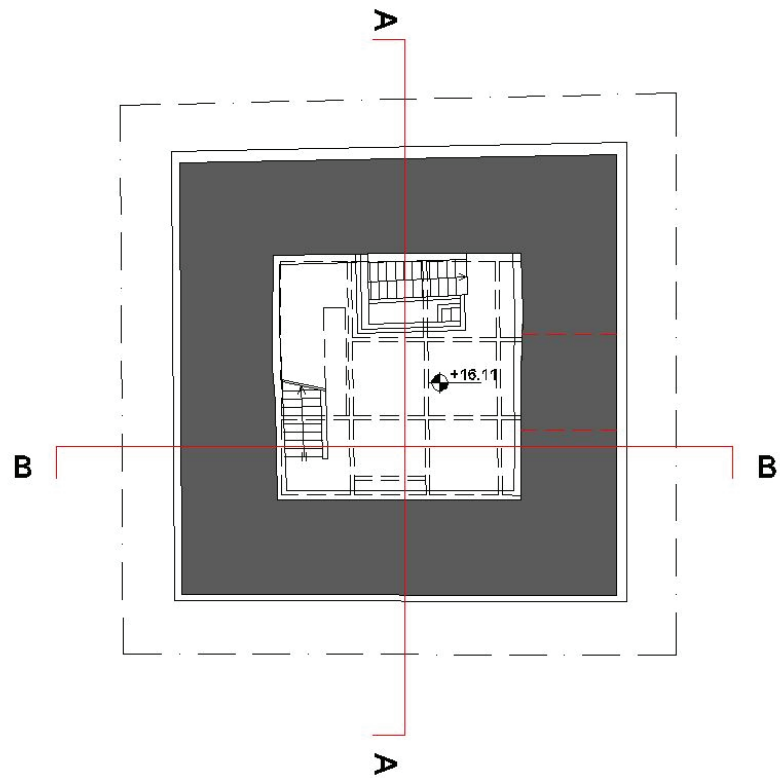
Pianta piano terzo della torre campanaria - Chiesa S. Francesco, Leonessa
